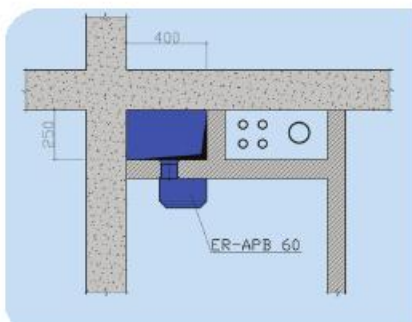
Установка вентилятора ER-APB-60 на стену шахты
